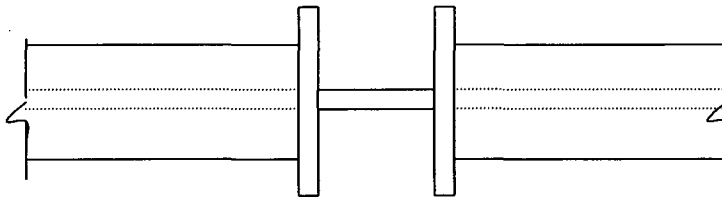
Ligação viga-pilar concentrada no eixo forte.
